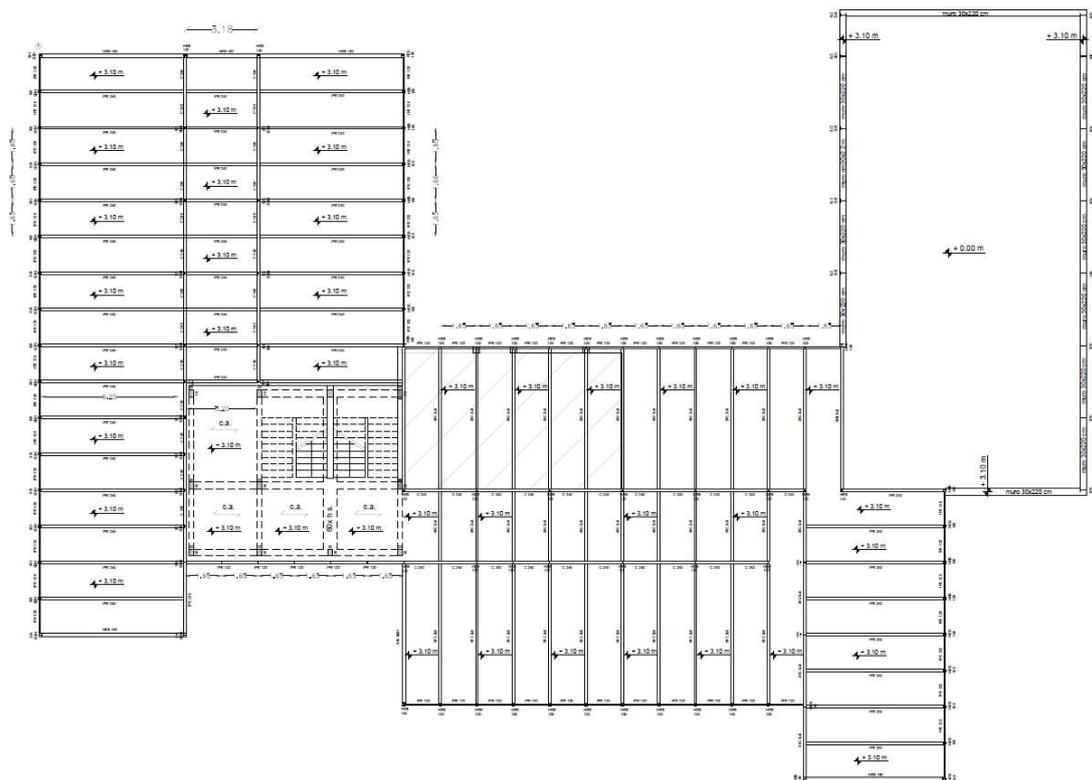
Schema carpenteria primo impalcato (piano terra)
